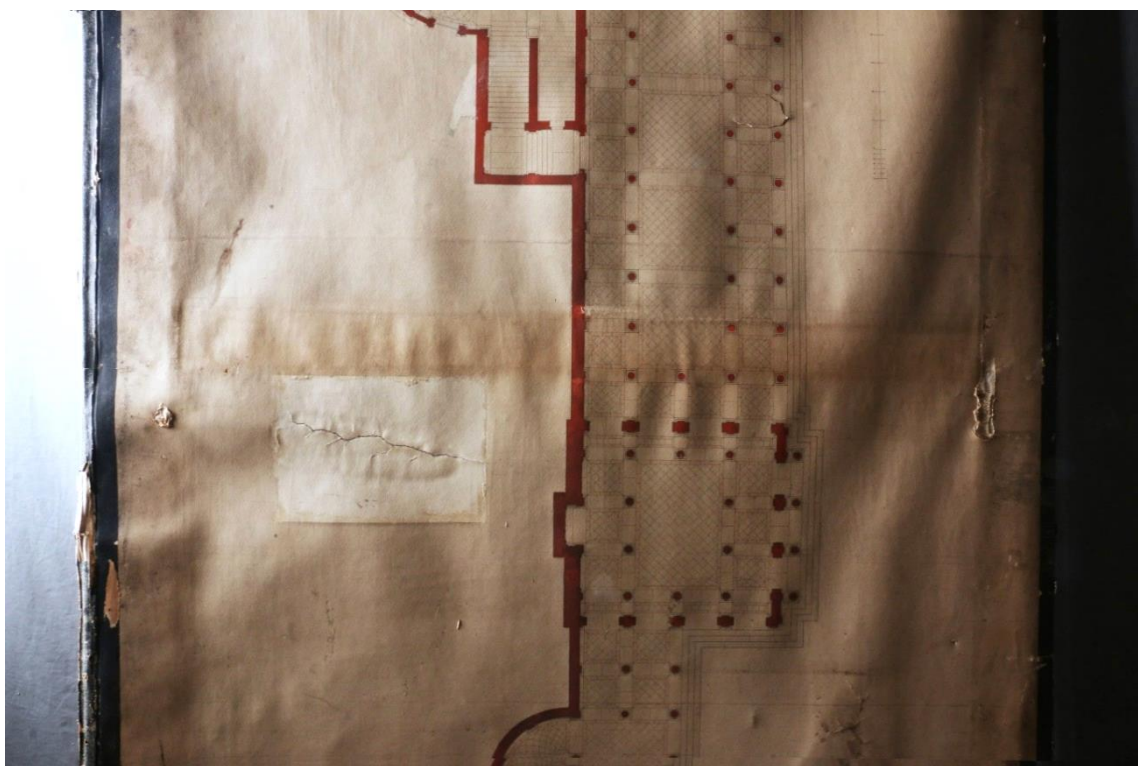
Detail plátěné záplaty nalepené na zadní straně díla, stav před restaurováním
